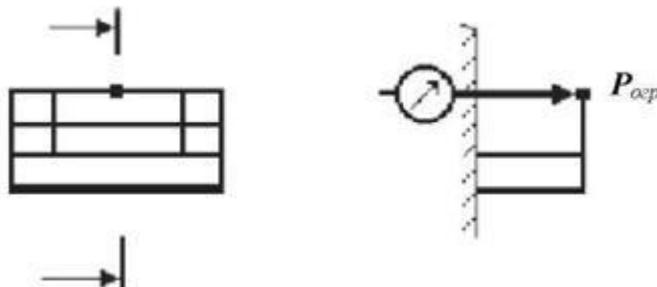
Схема приложения испытательной нагрузки для ограждения кровли, а также марша и площадки маршевой лестницы
